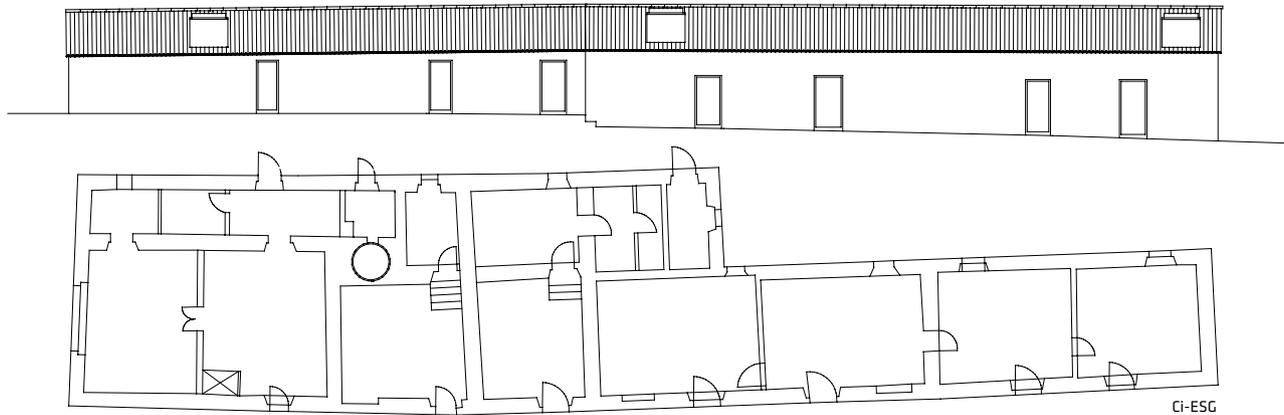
Planta e alçado frontal da Casa dos Romeiros, Alcácer do Sal Plan and main elevation of the Romeiros House, Alcácer do Sal
